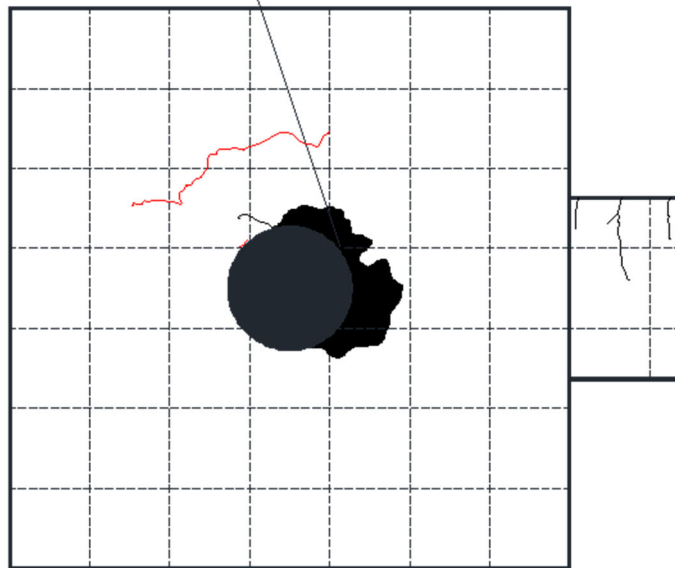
パイルキャップ底面ひび割れ幅測定位置 (試験体 DR-3 +7.0 サイクル)
